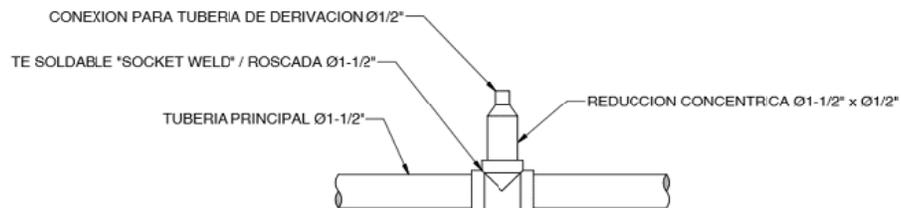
Conexión te soldable “socket weld” / Te roscada
